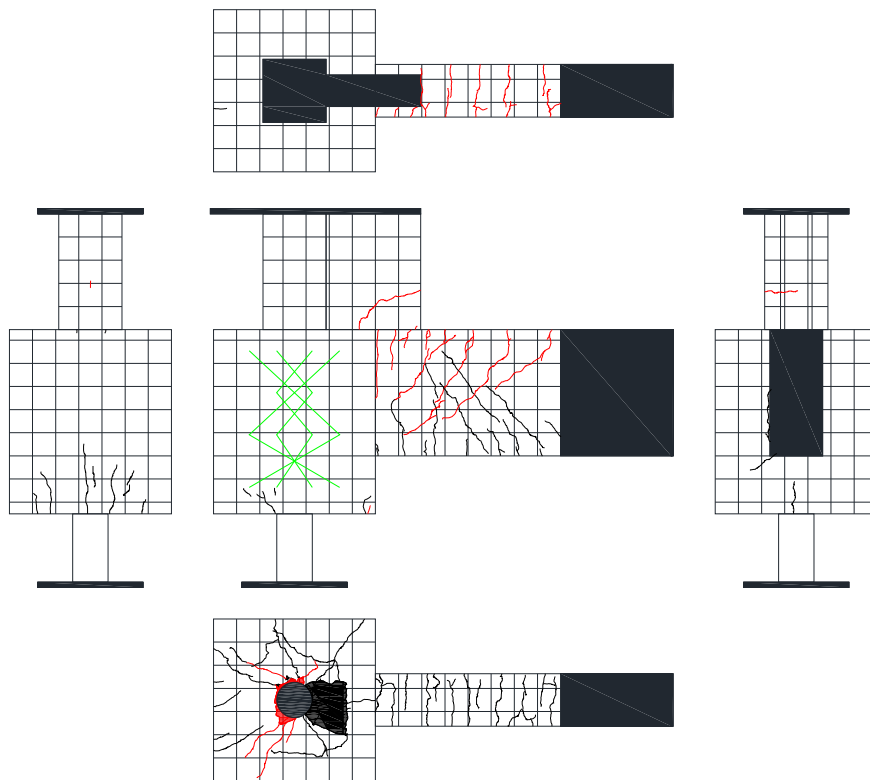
試験体 DR-1 ひび割れ状況 (8Cycle)
